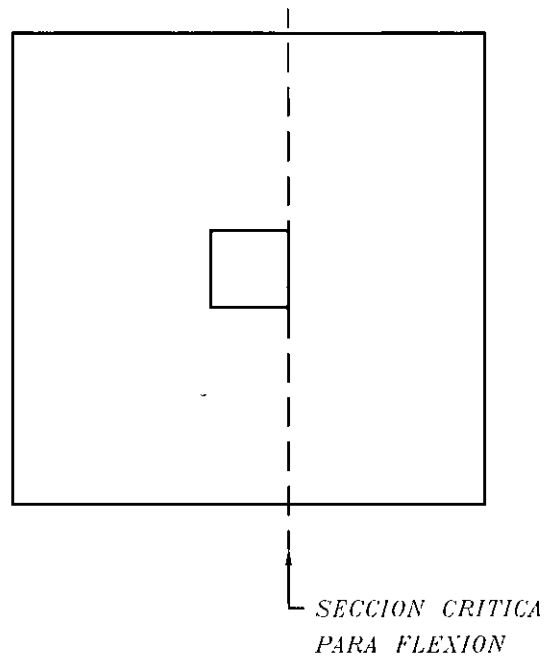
SECCIONES CRITICAS EN ZAPATAS AISLADAS
